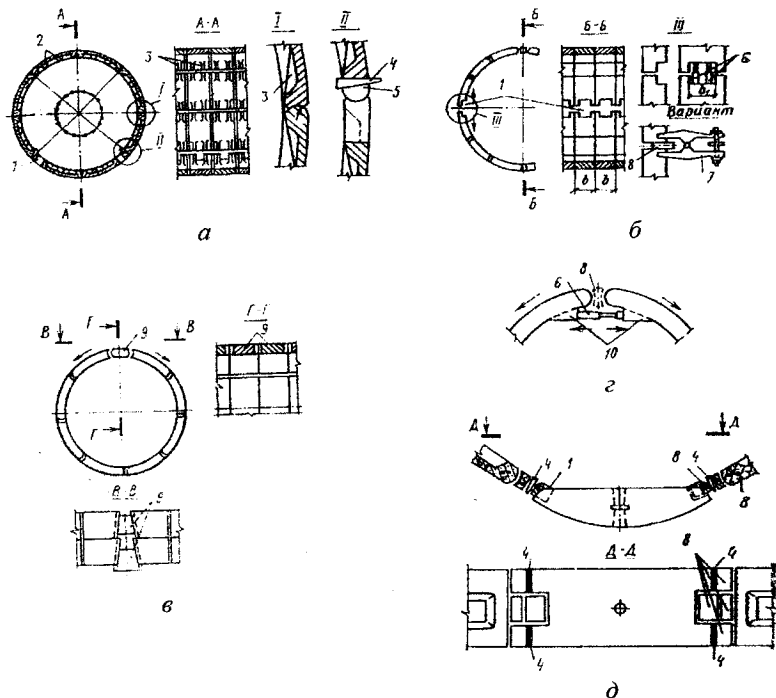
Конструкції кріплень, обтиснутих у ґрунт: *а* – з чавунних тубінгів; *б-д* – із залізобетонних блоків; 1 – проріз для домкрата, 2 – монтажні вушка; 3 – ребра жорсткості; 4 – клин; 5 – прокладка; 6 – домкрати; 7 – підіймний пристрій; 8 – вкладиш; 9 – клиновий блок; 10 – стовщення на суміжних блоках
